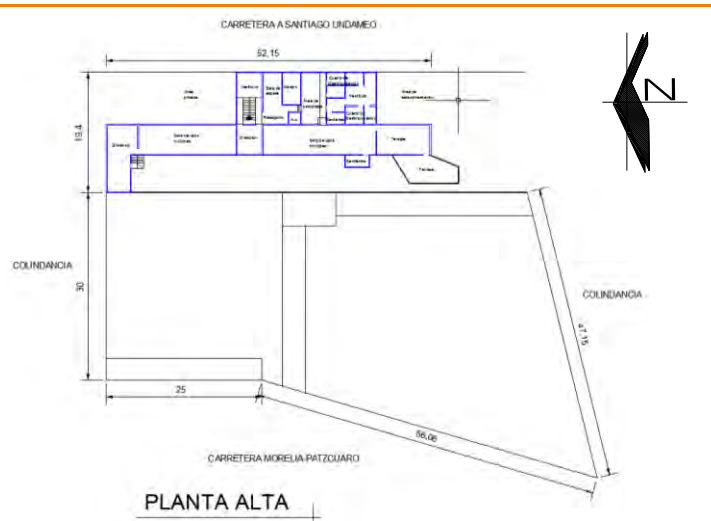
Croquis de planta alta de la Clínica Siete Ángeles, realizado por HGMB.
